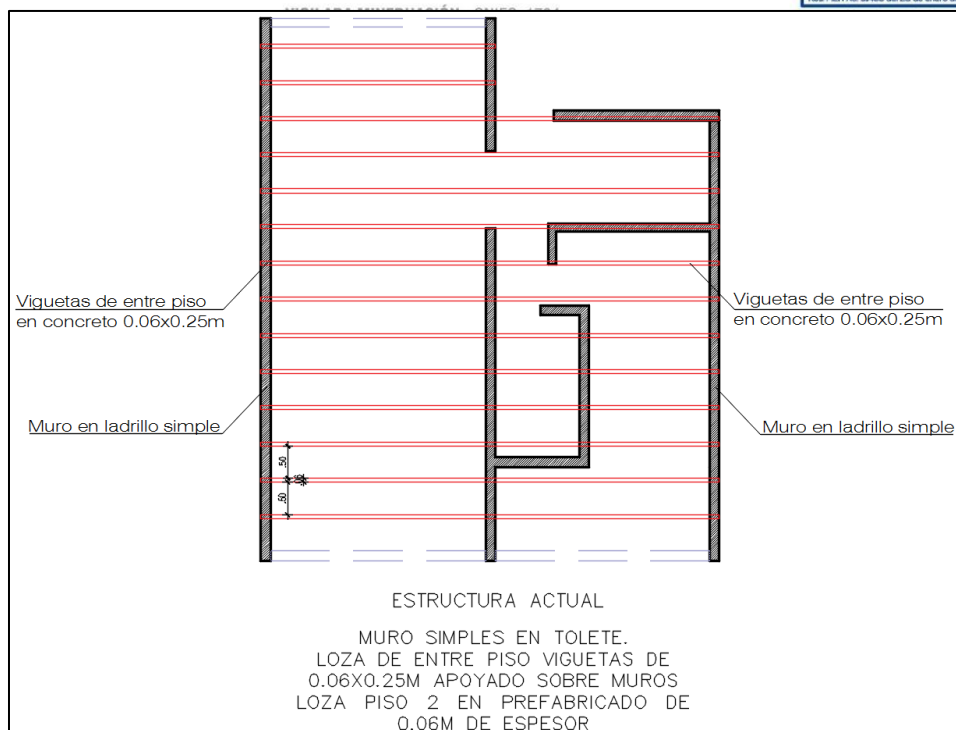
Plano estructura piso 1. Fuente: Los autores
